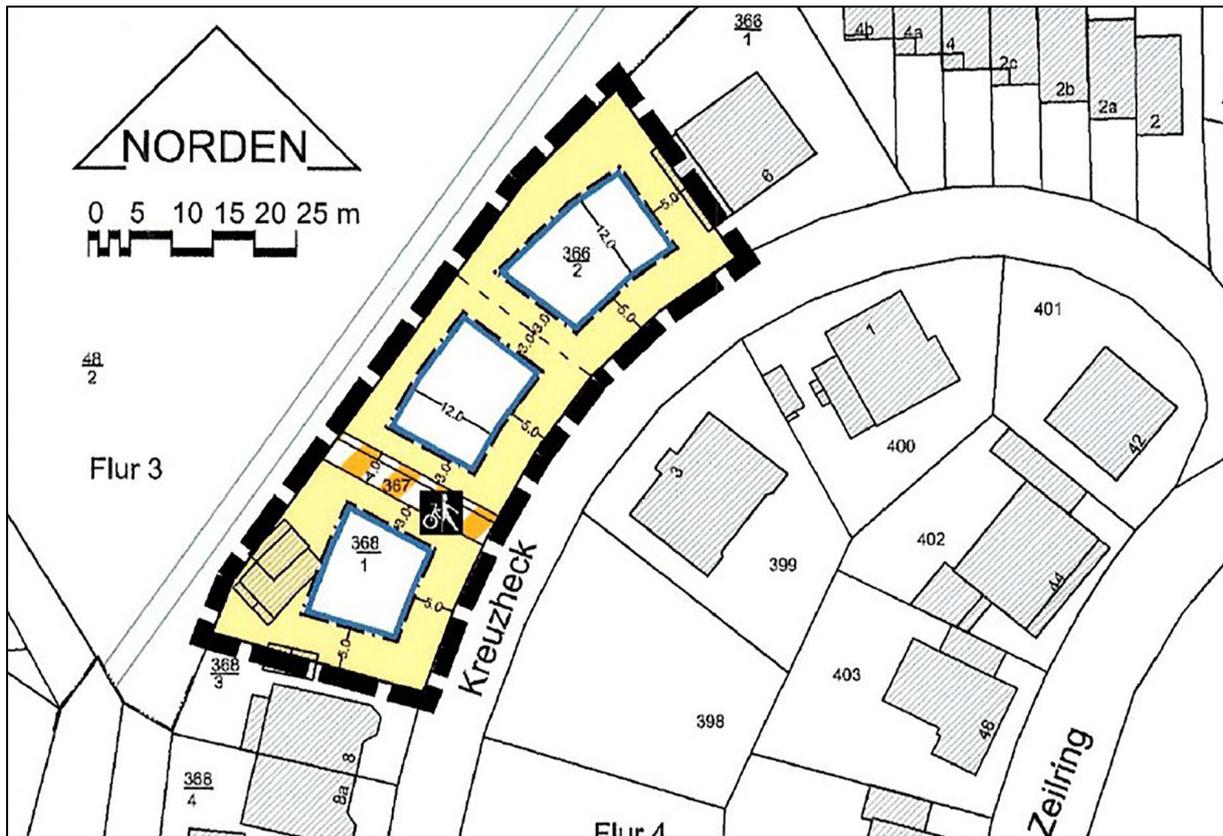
Geltungsbereich des Bauungsplans N 3 „4. Änderung Zeil“
